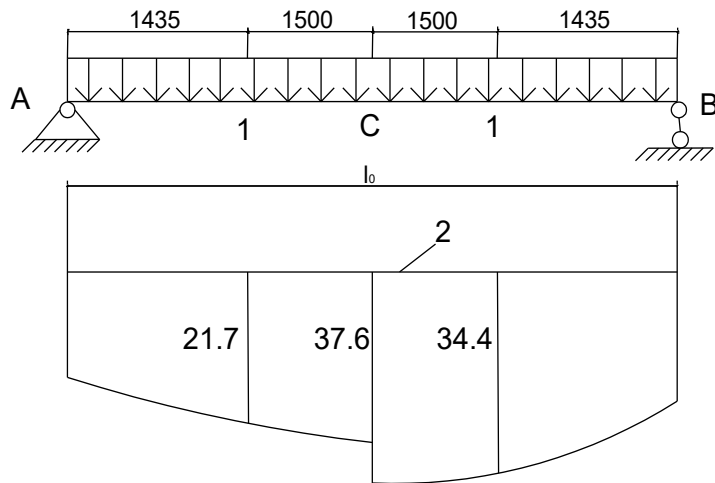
Переріз плити і еюра моментів до розрахунку по деформаціях до поздовжньої осі елемента, при утворенні тріщин
